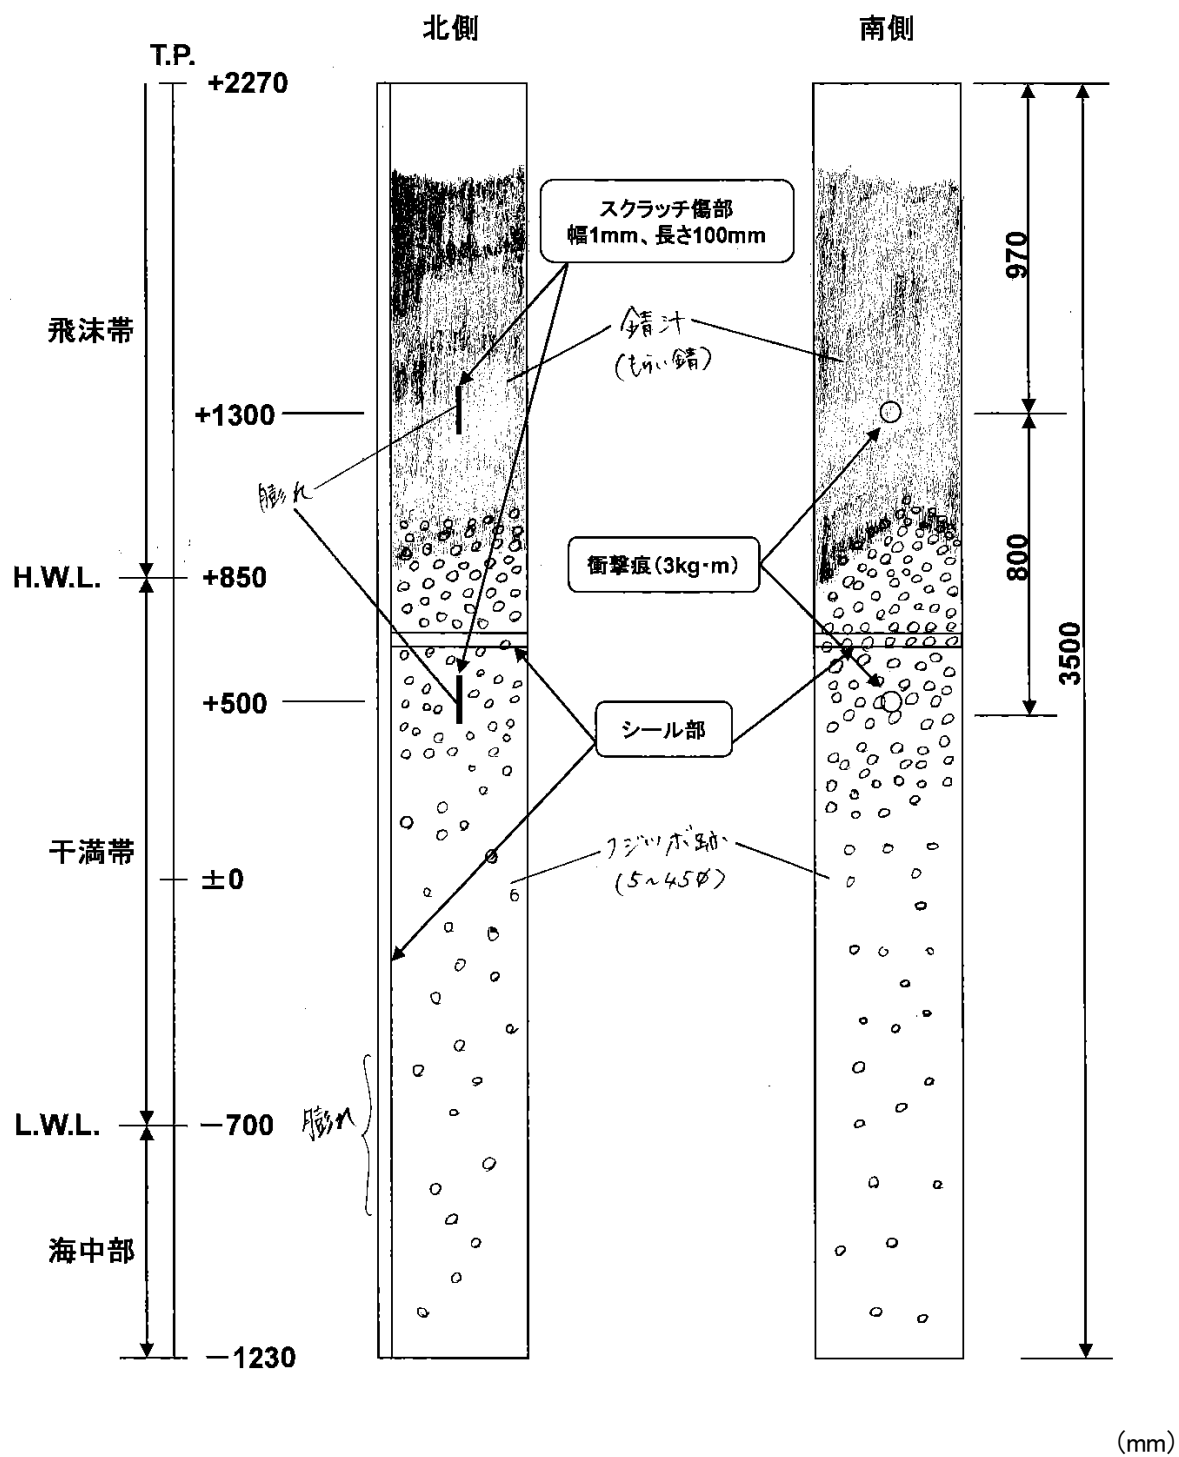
試験材N-15 海生生物除去前の外観状況写真
